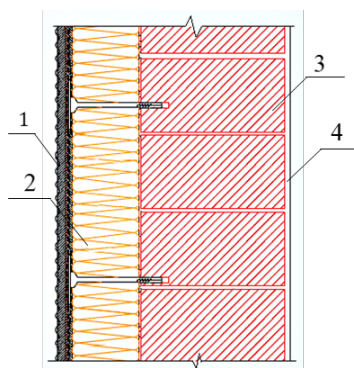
Состав слоев наружной ограждающей конструкции: 1 — наружный штукатурный слой; 2 — утеплитель; 3 — блоки из ячеистого бетона; 4 — внутренний штукатурный слой
